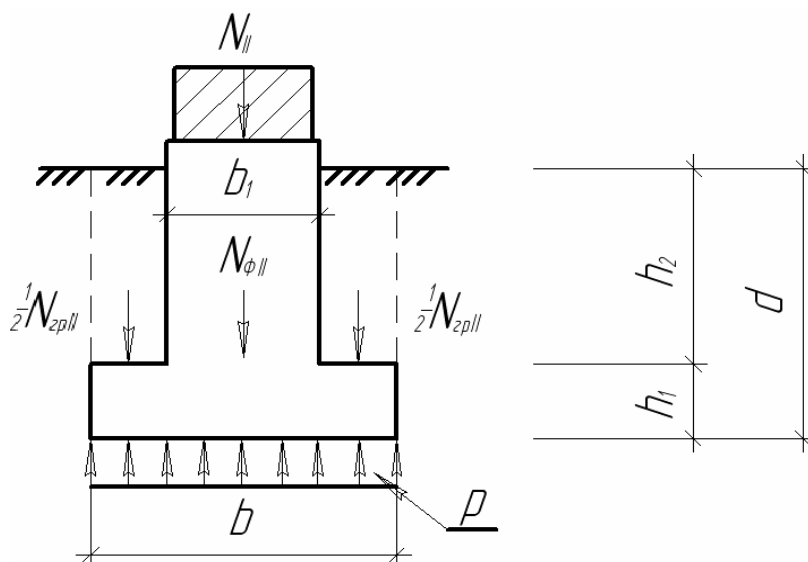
Нагрузки, действующие на ленточный фундамента.
